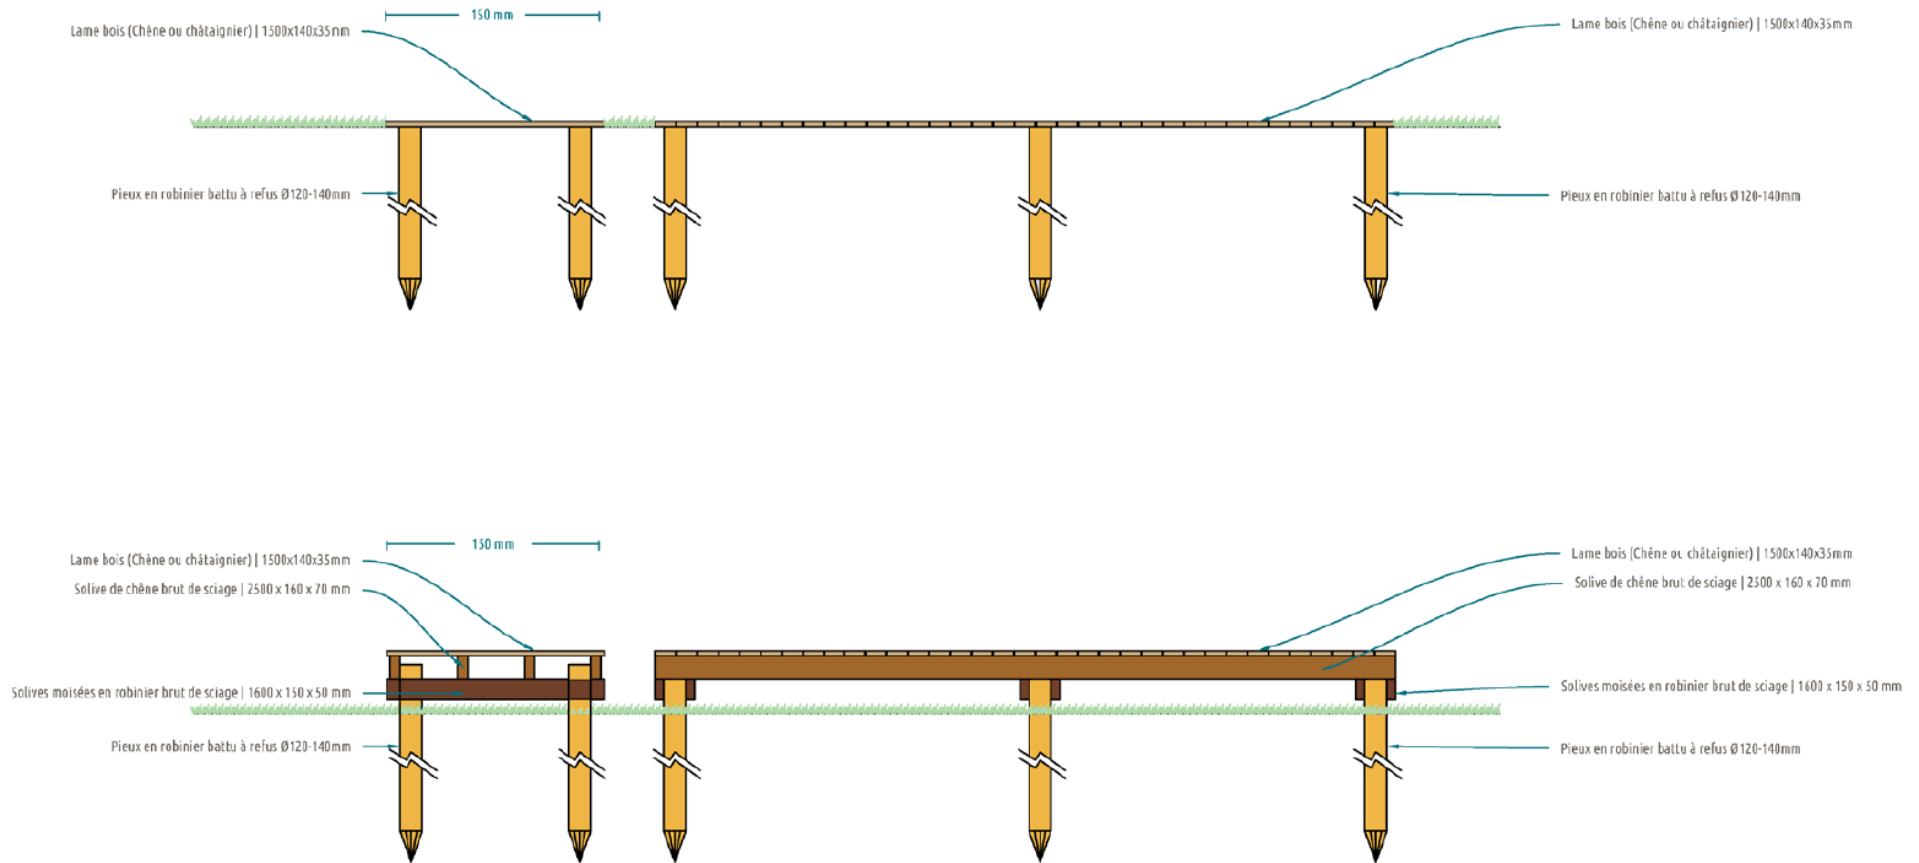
Ouvrage de Poulkao : coupe des platelages et pontons (source : Atelier Nāga)
